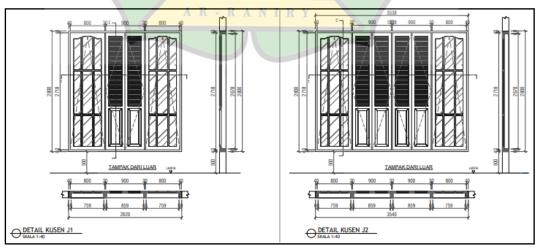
Rencana Kusen Bangunan Utama Lantai 2
